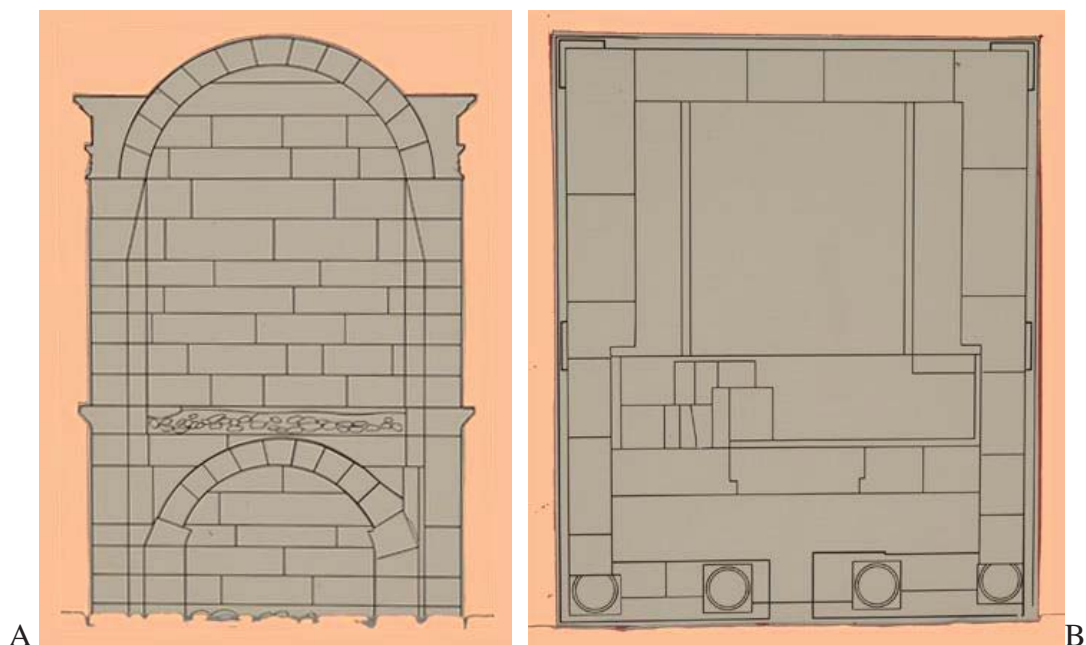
Alzado (A) y planta (B) del Mausoleo de Fabara
